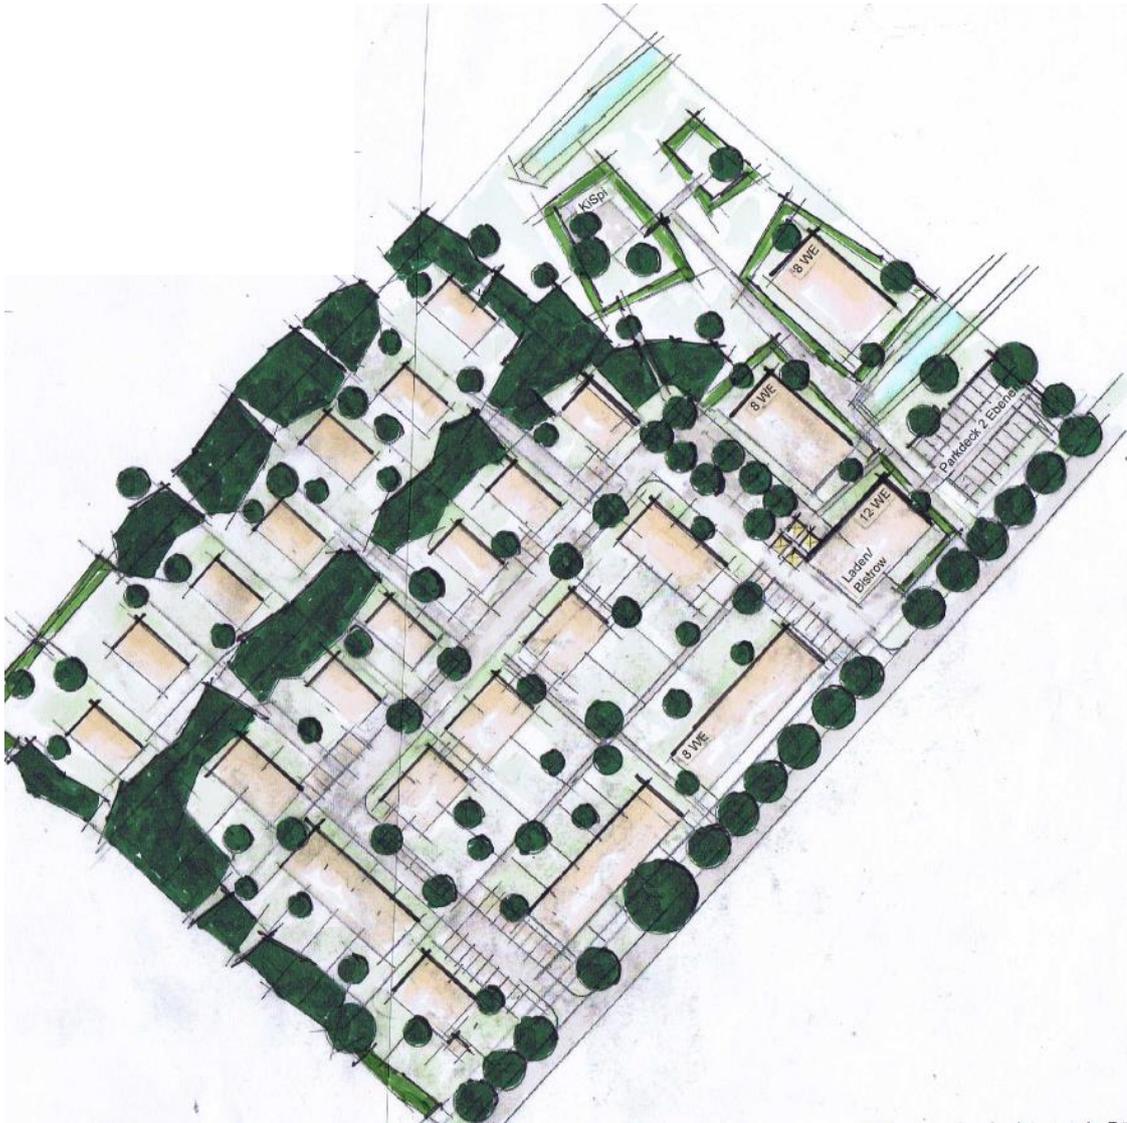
Alternative Planungsansätze - Variante 1 „Konventionelle Erschließung“
